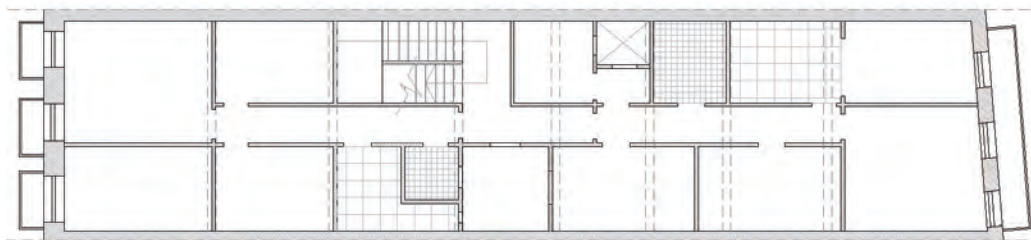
9. SEGUNDA Y TERCERA PLANTA
